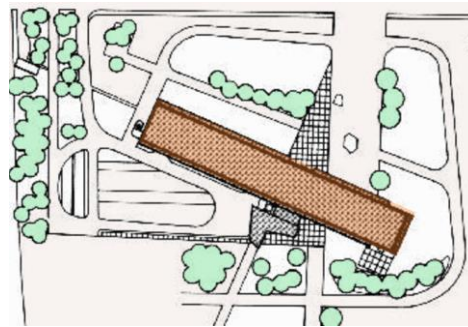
Burroughs Adding Makine Şirketi Planı, Detroit, 1904, Albert Khan (Url-46)
